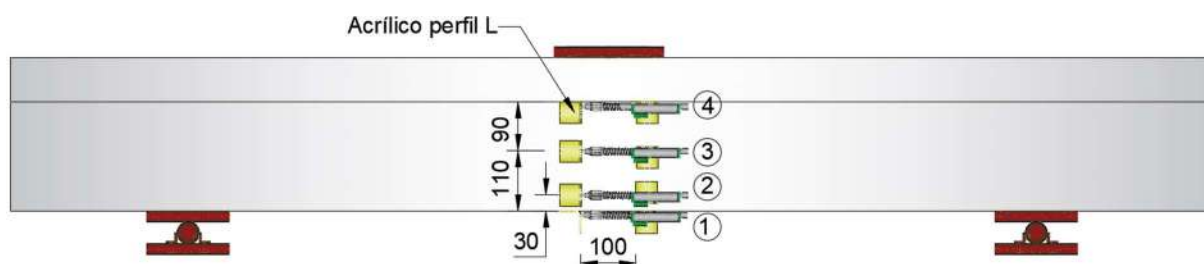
Posicionamento dos LVDT's para medição das aberturas de fissuras (mm).
